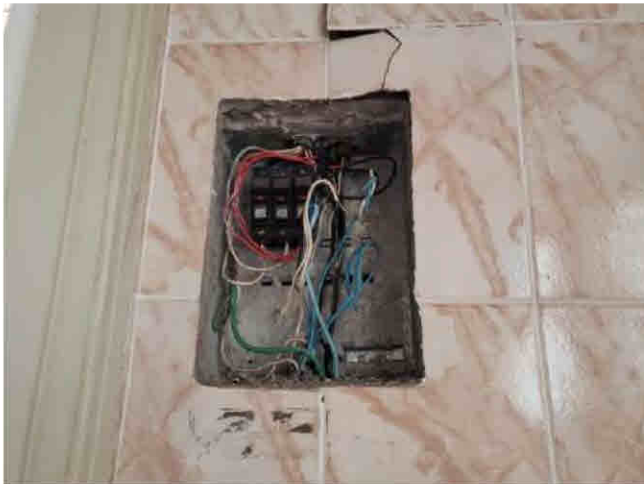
Detalhe para instalações elétricas incompletas – ausência de tampa do quadro
